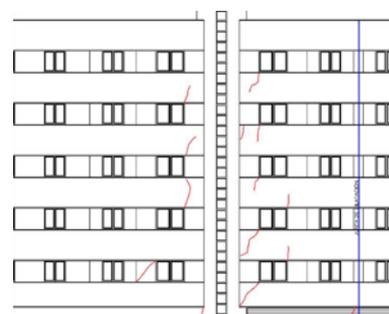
Fisuraciones en fachada por asientos de cimentación
